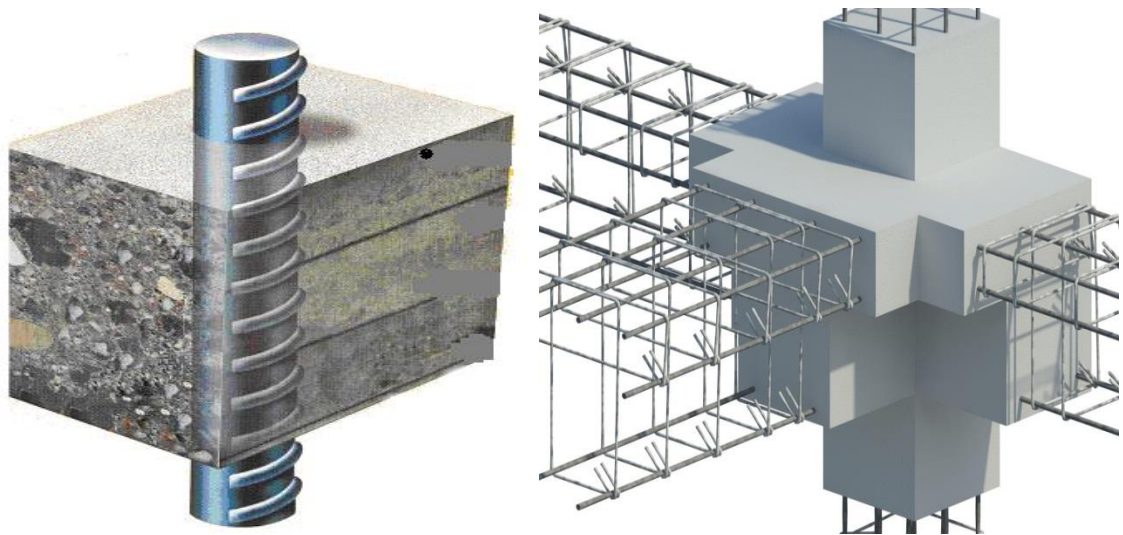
Concreto reforzado con acero sismo resistente.⁵⁴
